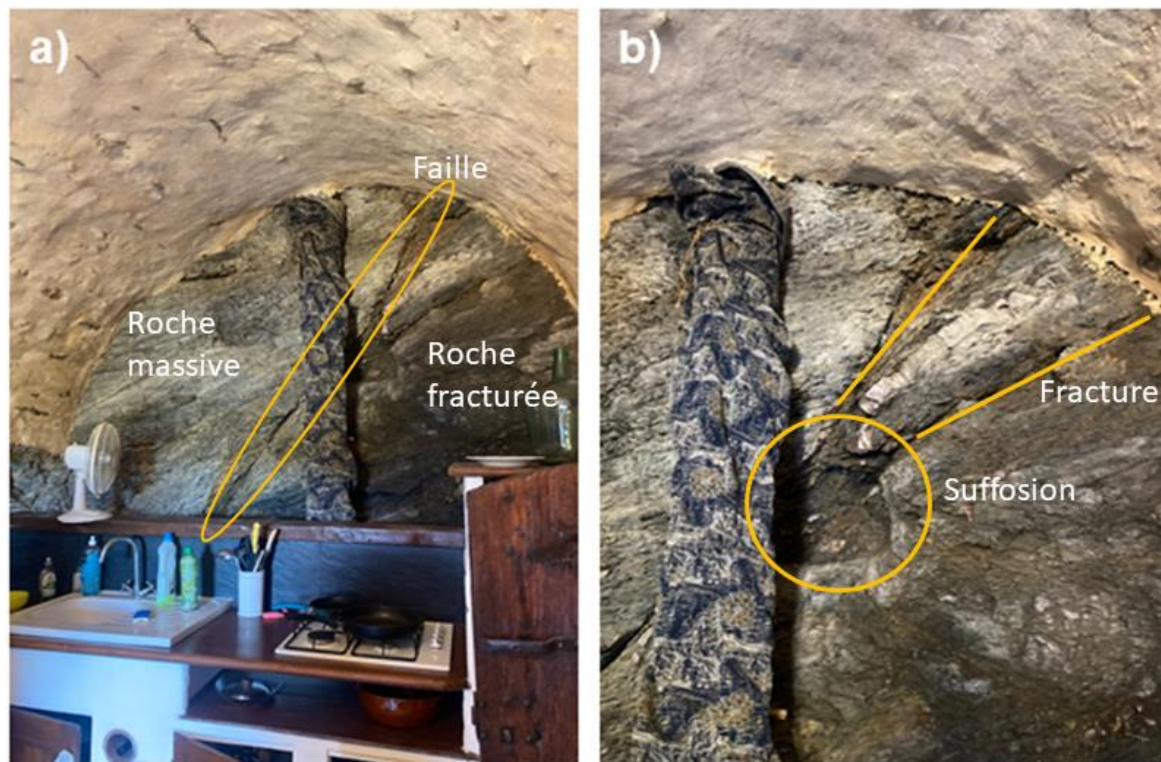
N°2 rue sous les fenêtres : a) mur du fond concerné par les infiltrations, b) Faille visible, structure drainante.
